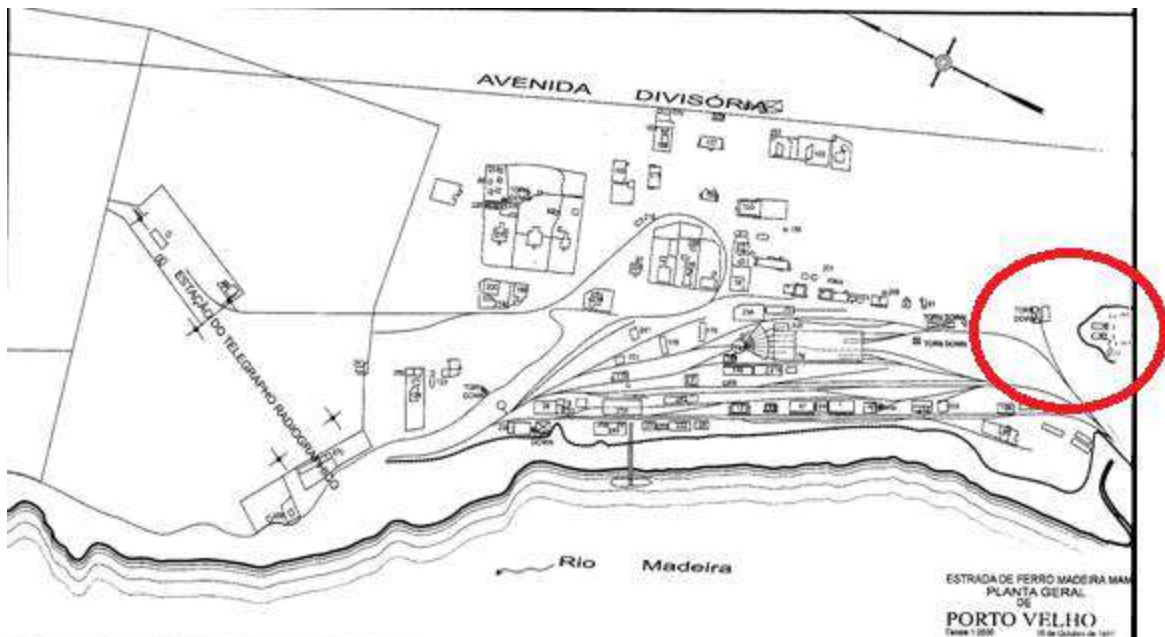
Figura 2. Planta de Porto Velho em 1917. Fonte: Arquivos da Madeira Mamoré Railway Co. Centro de Documentação do Estado. Marcação da autora para a localização do Barbadoes Town.
